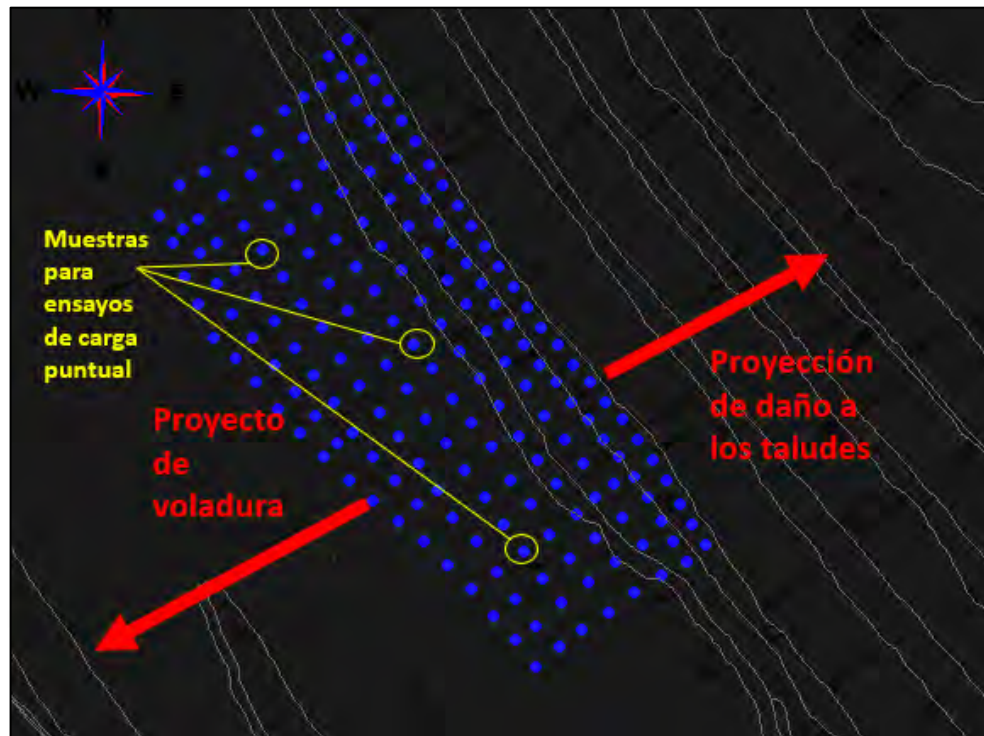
Vista en planta de proyecto de voladura del sector suroeste del tajo.
